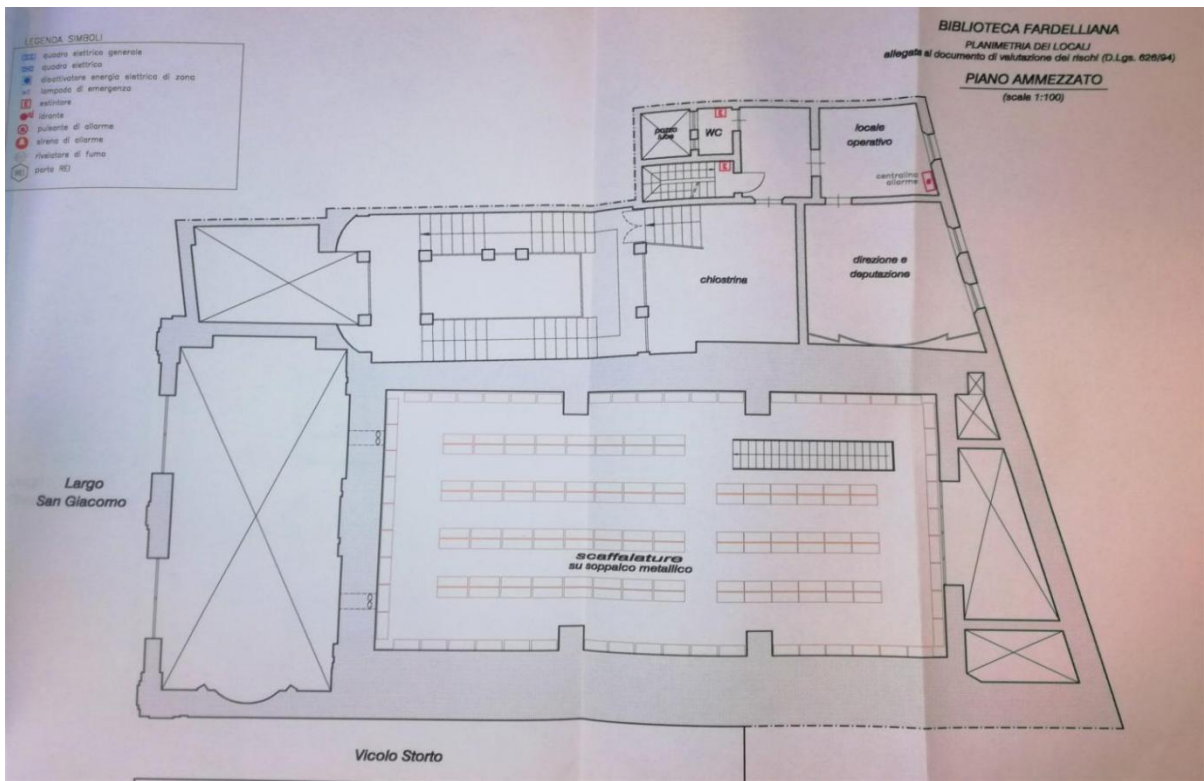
Planimetria Piano Ammezzato della 'Biblioteca Fardelliana'
